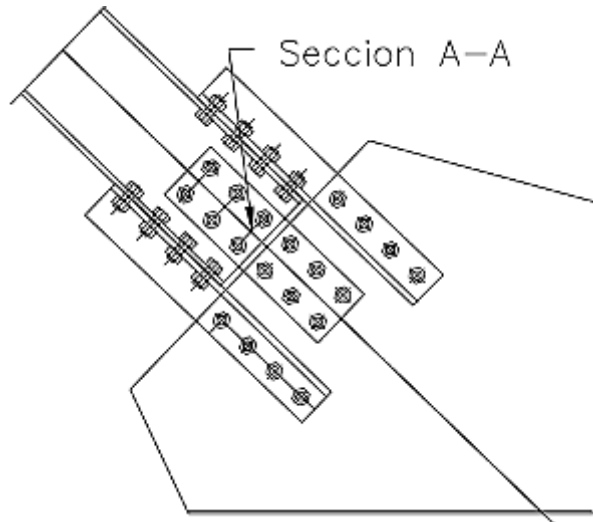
Área neta efectiva del arriostramiento en sección A-A. Fuente: Propia realizado en AUTOCAD.
